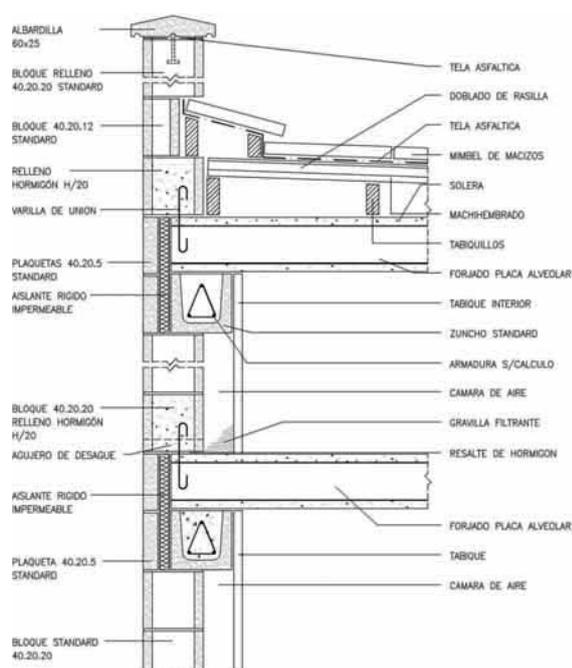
Secciones de encuentro de muro de 1 hoja de bloque hueco de carga con forjado de placa alveolar y peto de cubierta.
